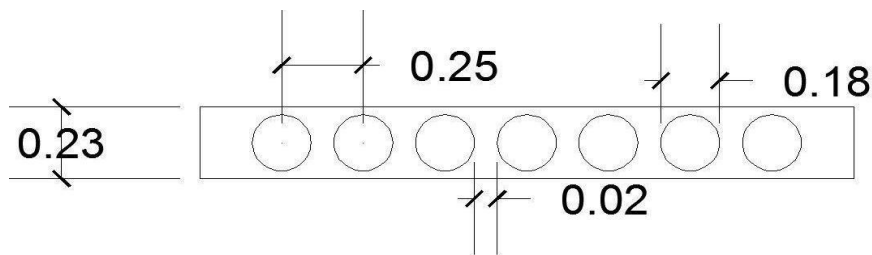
Geometría de la sección transversal para losas BD 230.
